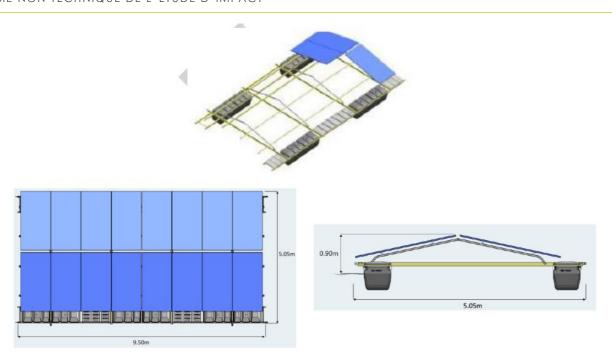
Technologie ponton – Dimensions d'une structure flottante
